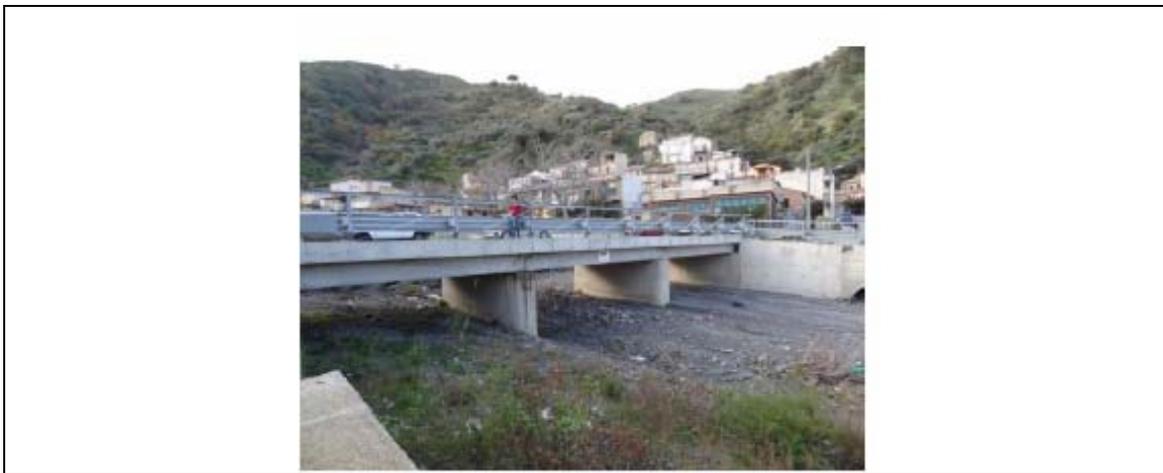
Torrente San Filippo: Manufatto P1a_SF: vista da valle
